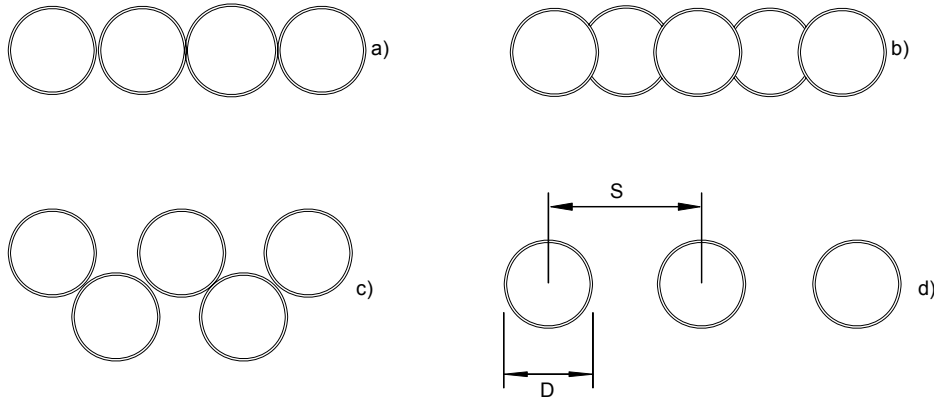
Arreglos en planta de muros de pilas de concreto armado (Cornforth 2005).
